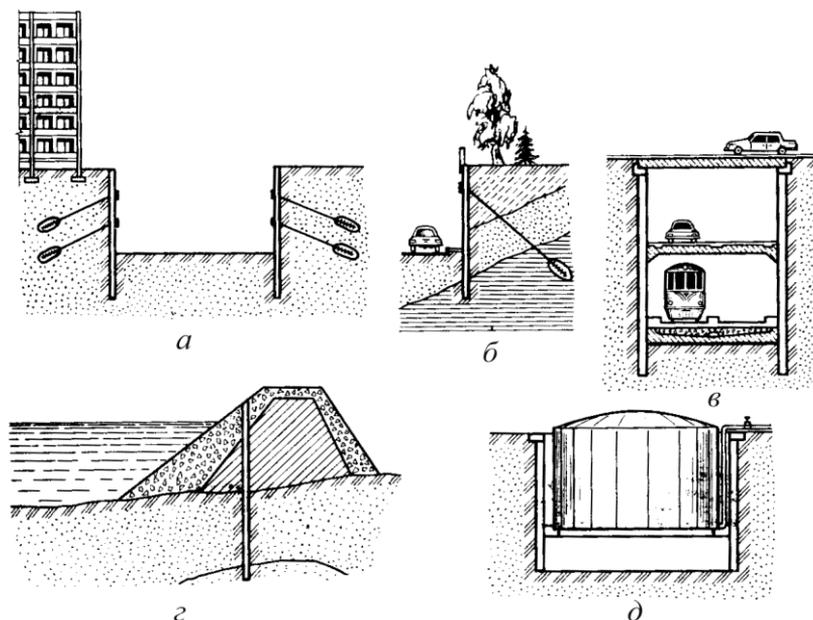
Примеры использования конструкций «стена в грунте»: *а* – устройство котлованов; *б* – подпорные стенки; *в* – тоннели; *г* – противофильтрационные диафрагмы; *д* – подземные резервуары
